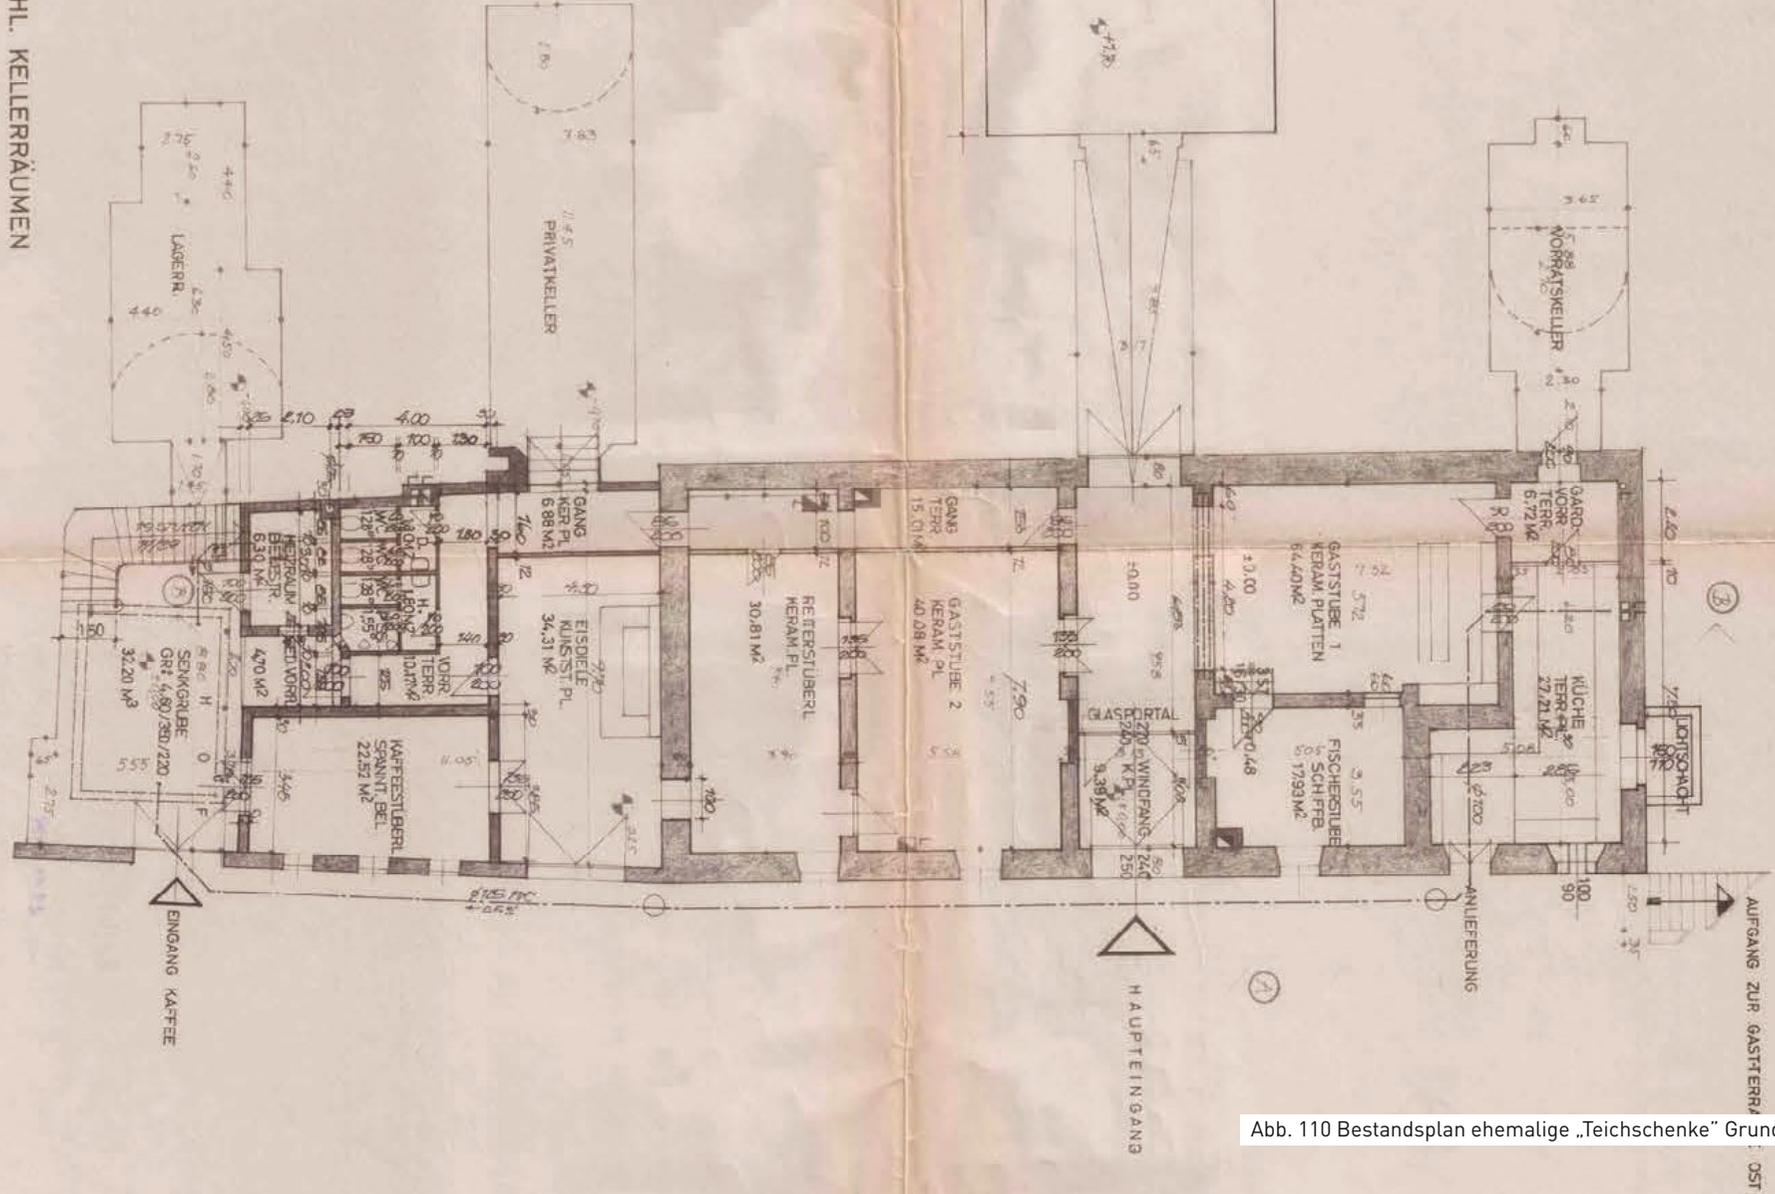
Bestandsplan ehemalige „Teichschenke“ Grundriss EG (1980)
